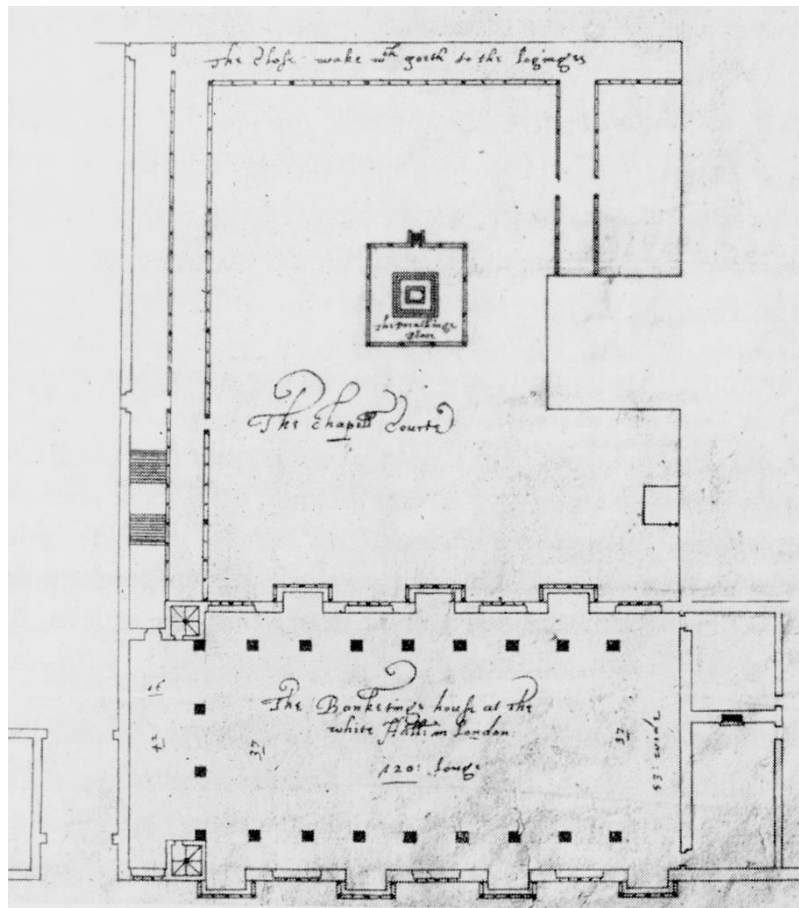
Anonym, *Banqueting House*, Grundriss,
